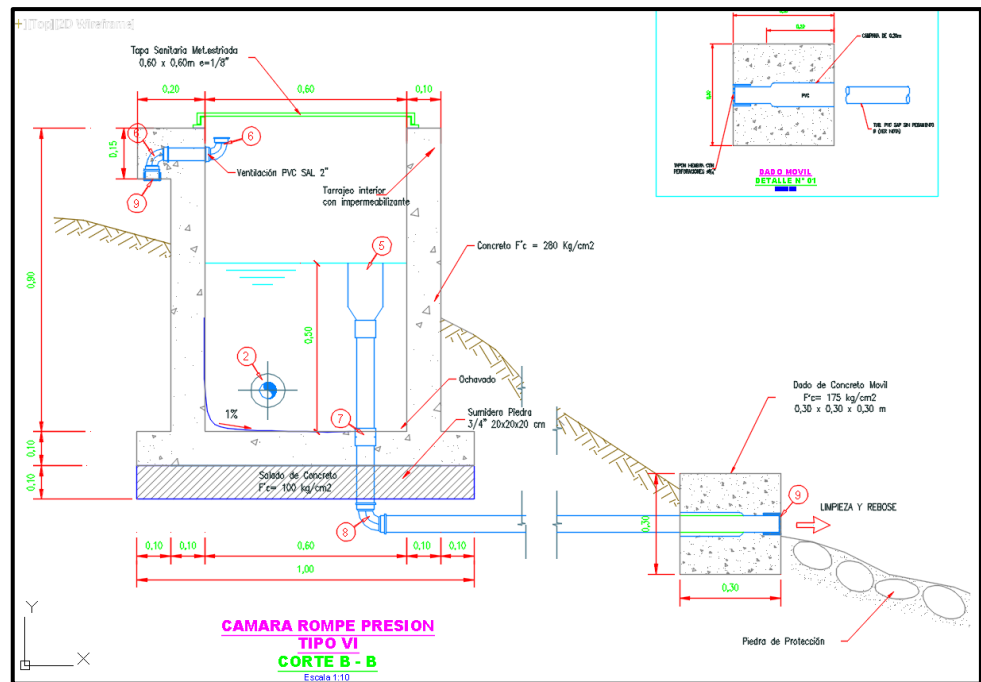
Planteamiento de Cámara Rome Presión Corte B-B
